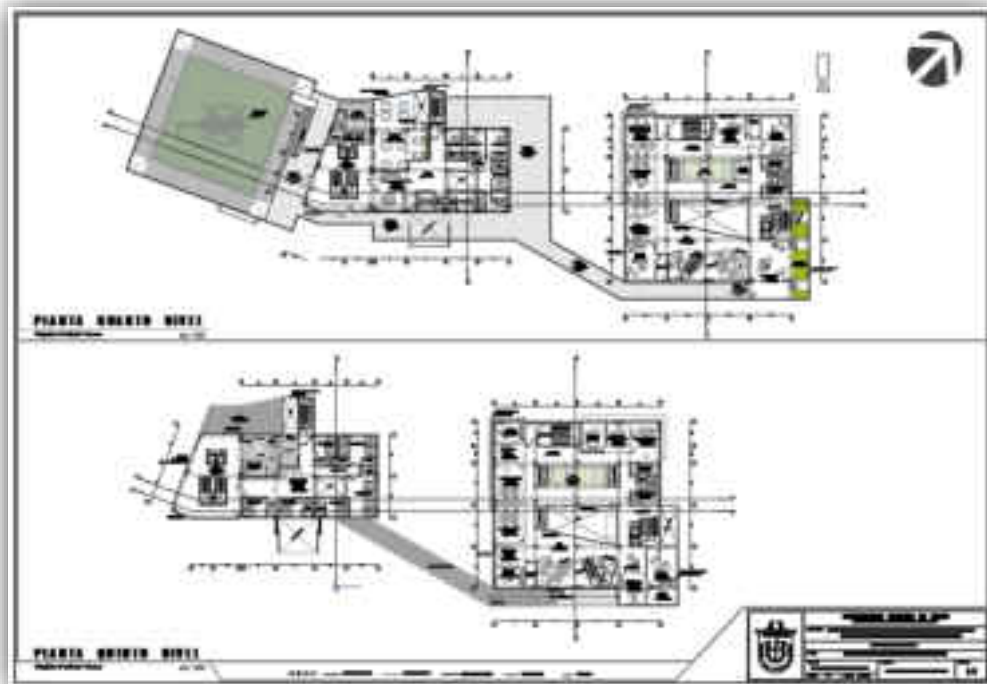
Anteproyecto - Planta cuarto y quinto nivel
